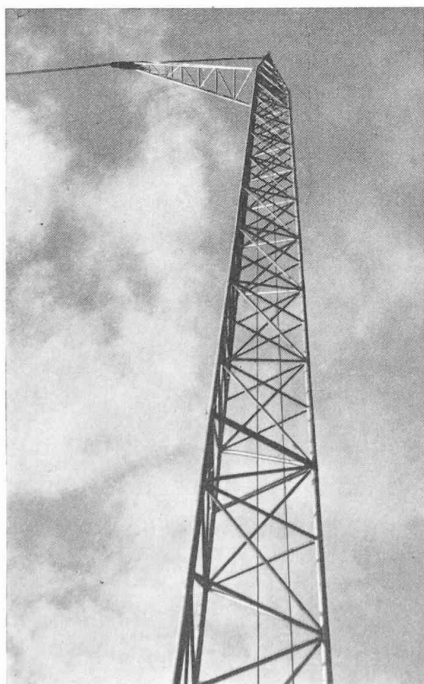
Derrick de montage, hauteur 46 m, en tubes d'acier soudés.
